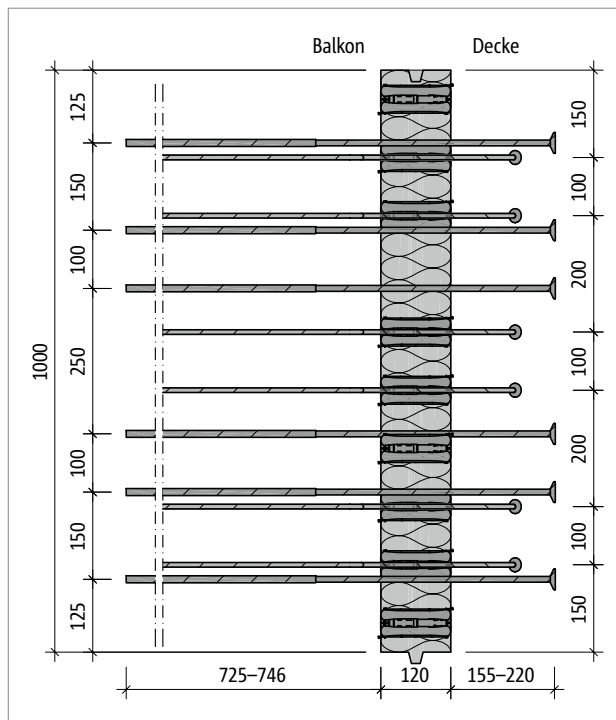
Schöck Isokorb® XT Typ KL-U-M2: Produktgrundriss
